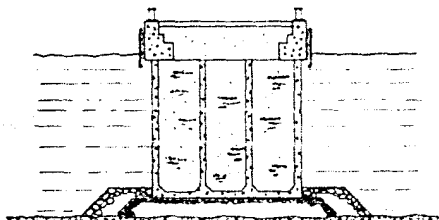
Cajones de concreto armado tipo de fondo cerrado.
